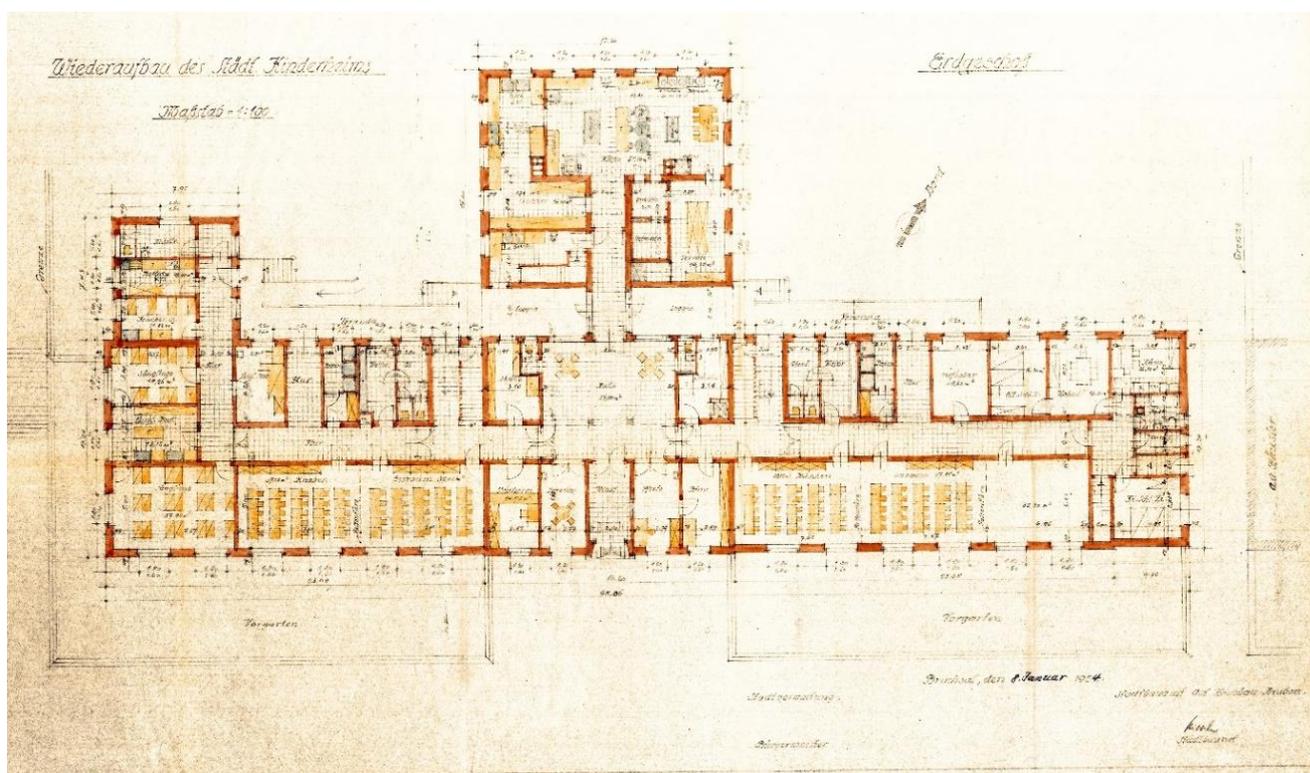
Plan Erdgeschoss des Kinderheim-Neubaus vom 8.1.1954, StAB 471/2.
